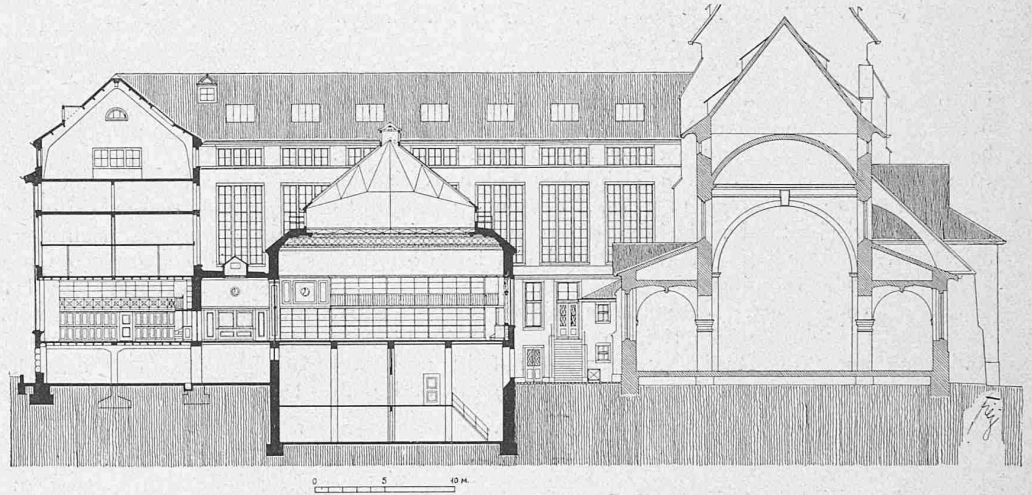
und 6. Erdgeschoss-Grundriss und Querschnitt durch Lesesaal und Kirche. — Masstab 1:500.
